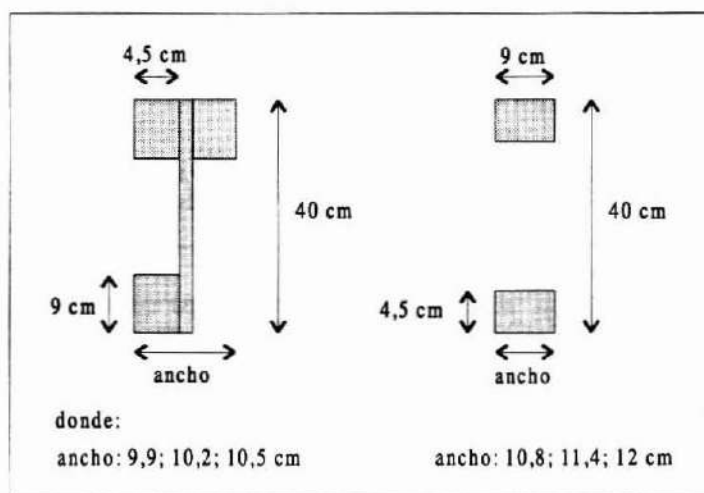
SECCIÓN CRÍTICA, QUE CORRESPONDE A LA DISCONTINUIDAD TANTO EN LAS ALAS DE LA VIGA DOBLE T COMO EN EL CENTRO DE LA VIGA CAJÓN.
